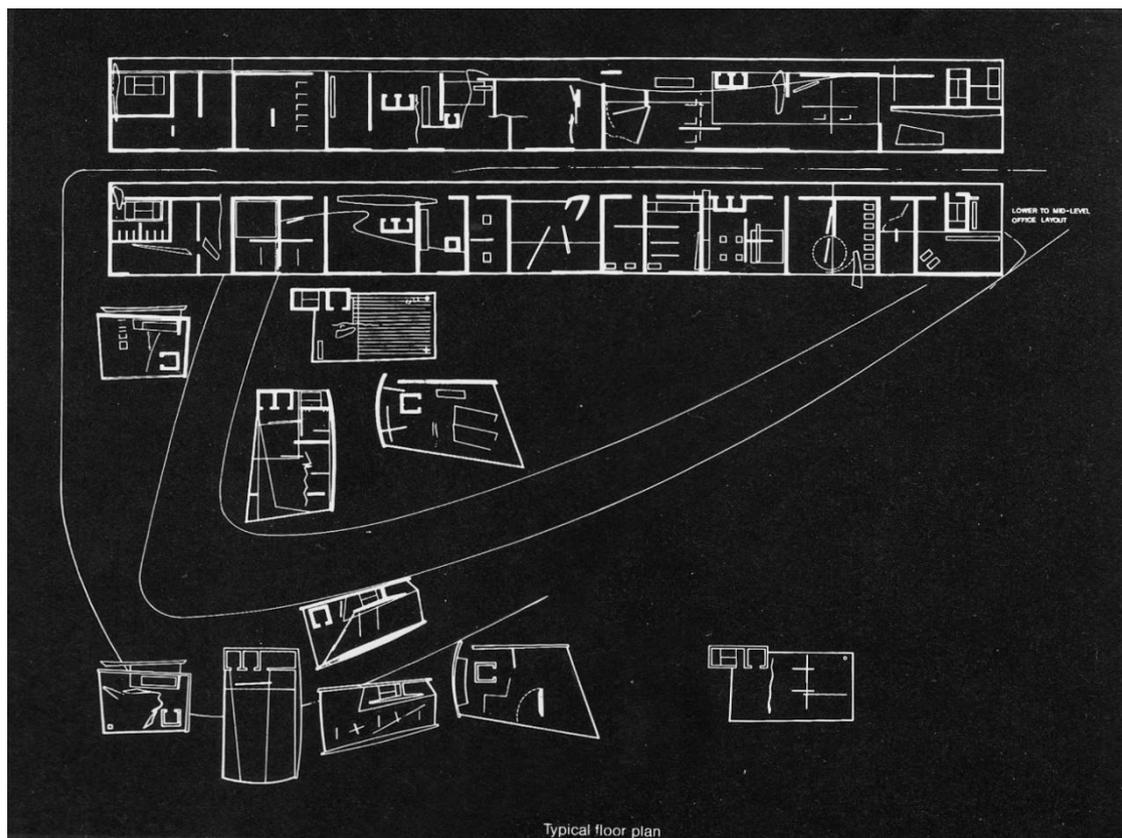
Zaha Hadid, Trafalgar Square Grand Buildings Project, planta baixa, 1985.
